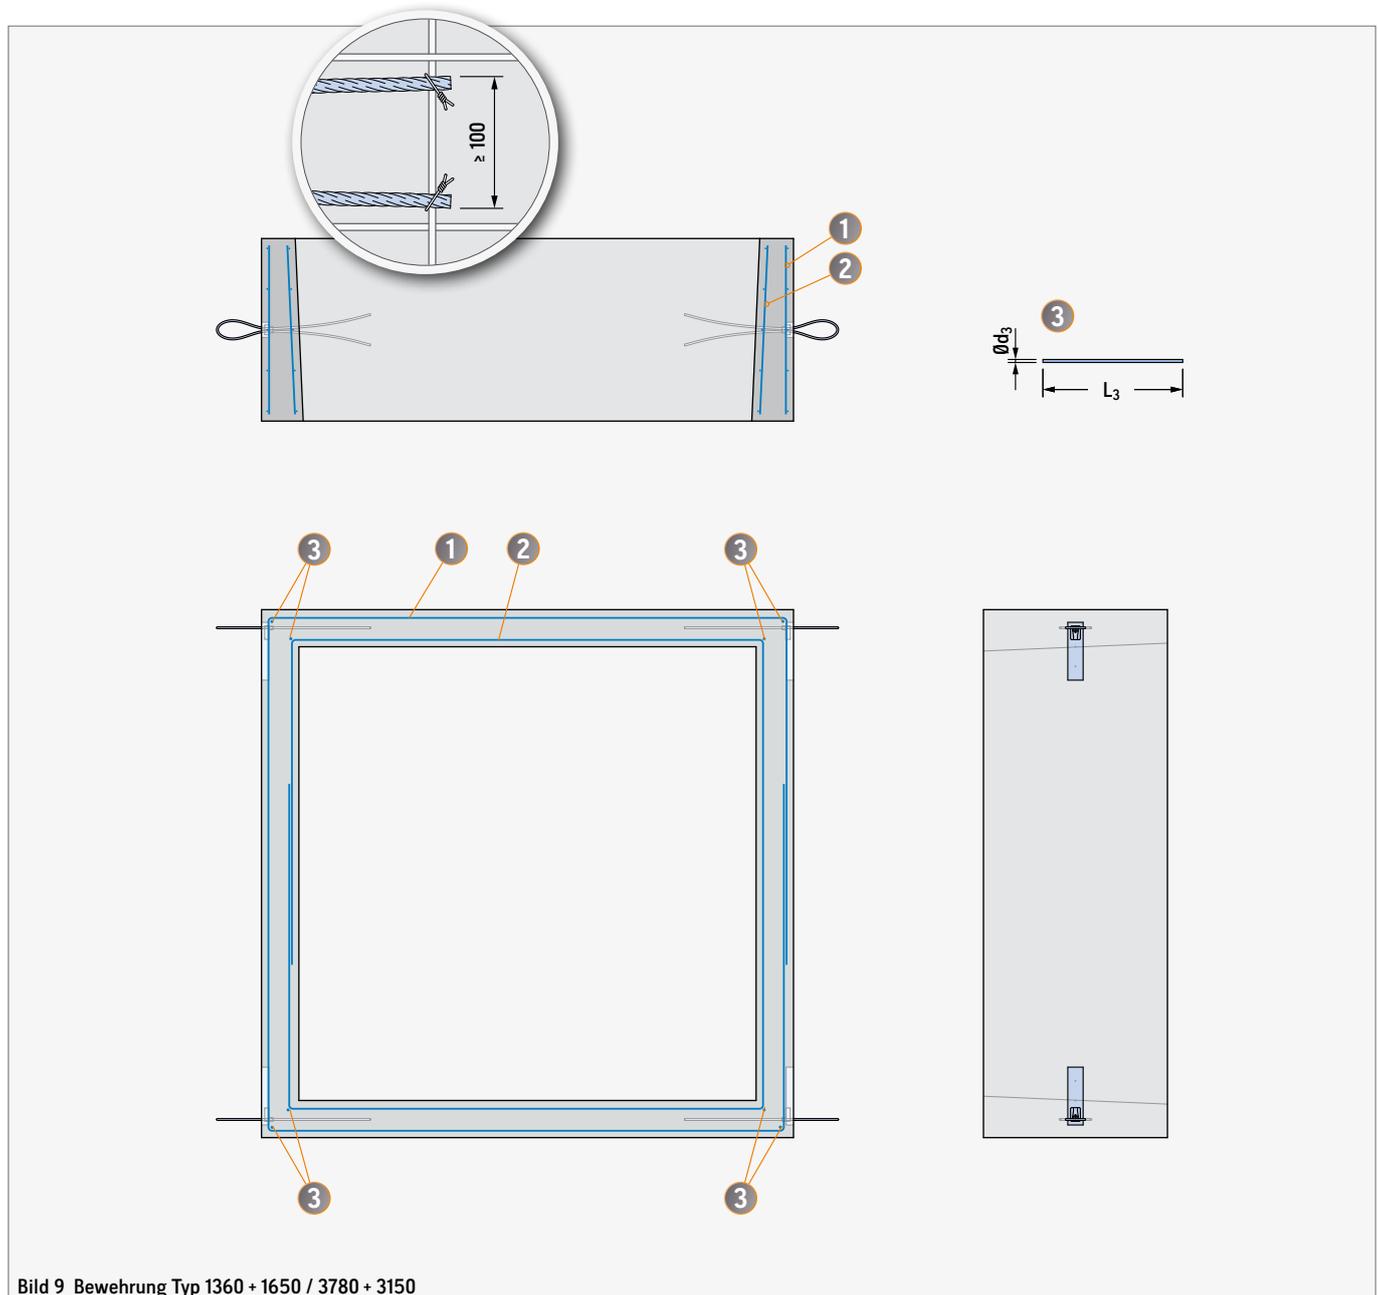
Bewehrung Typ 1360 + 1650 / 3780 + 3150
